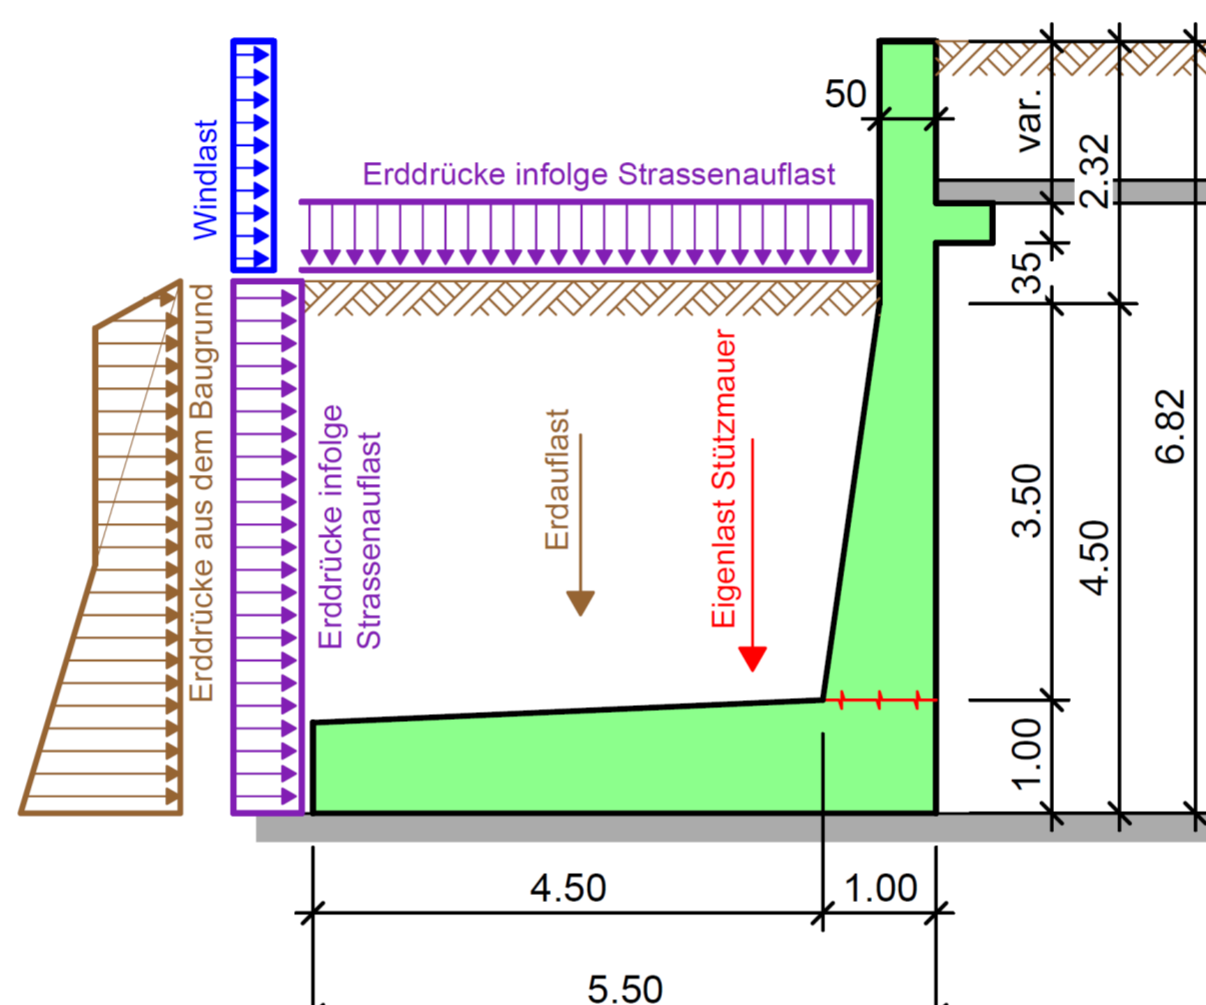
Schnitt Bemessung Stützmauer (roter Bereich)
